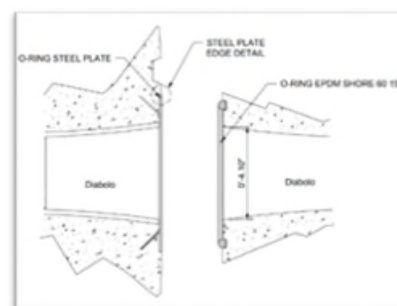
Detalle de conexión en juntas para instalación y sellado del sistema de postesado.
